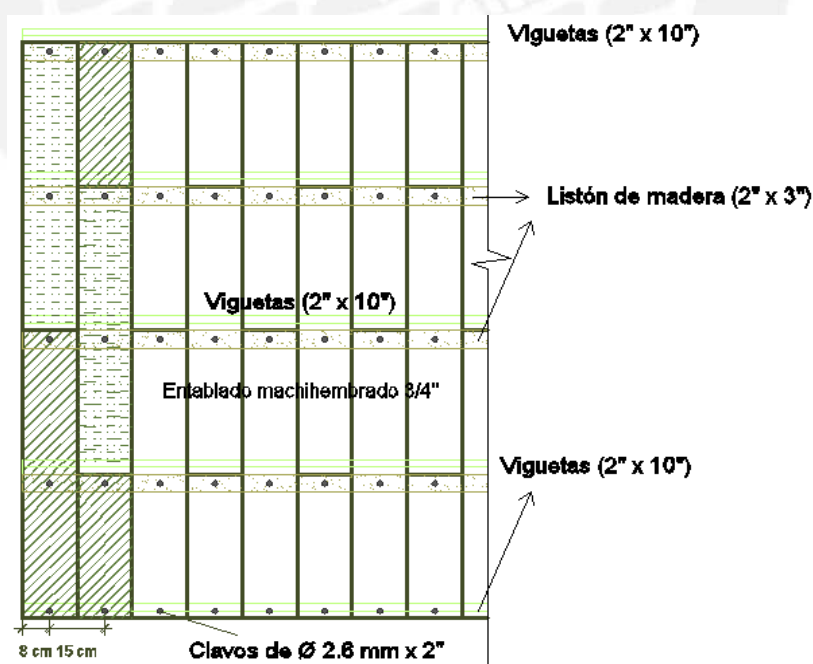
Esquema de unión Entablado – Viguetas (Paño 1 entre ejes B-C/1-2)
